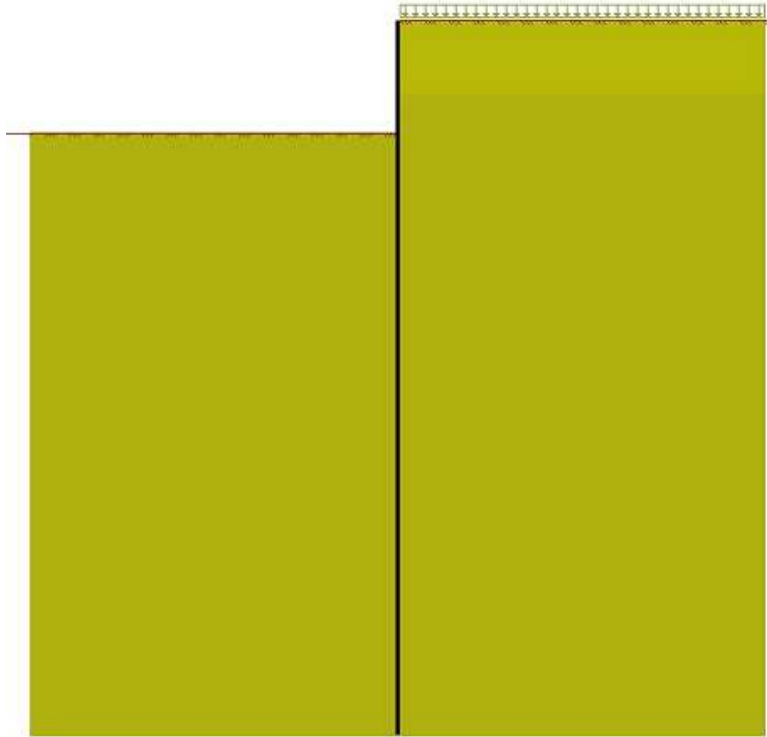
Excavation jusqu'à la profondeur de 3m.
